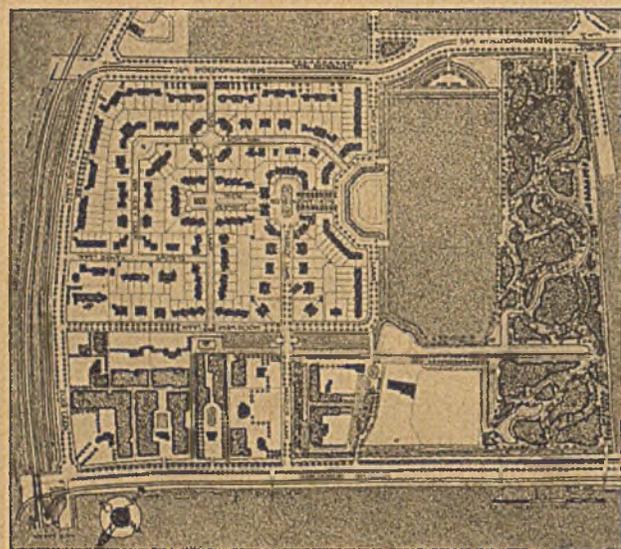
Landhaus-Siedlung am Park Marlot (Den Haag). Vom internationalen Städtebau-Kongreß in Amsterdam.
